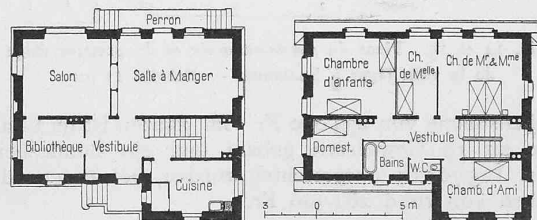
et 6. Plans du rez-de-chaussée et du premier étage de la villa Lugeon. — Echelle 1 : 400.
